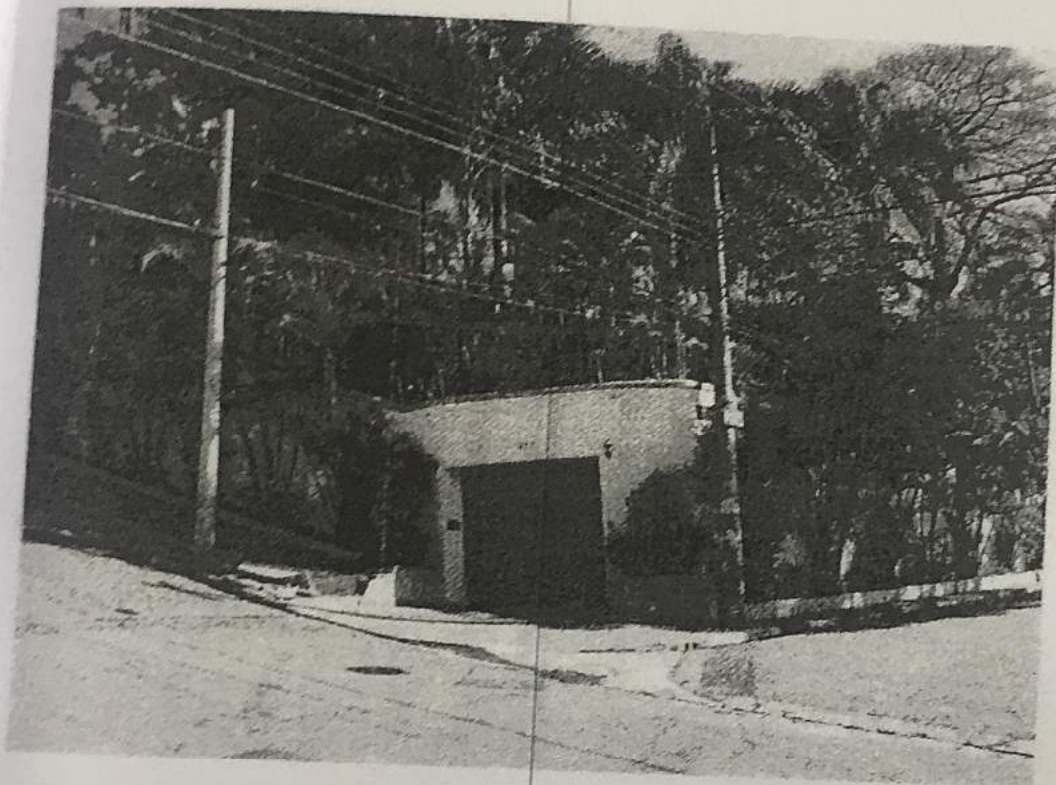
VISTA GERAL DO IMÓVEL SITUADO ENTRE A RUA
